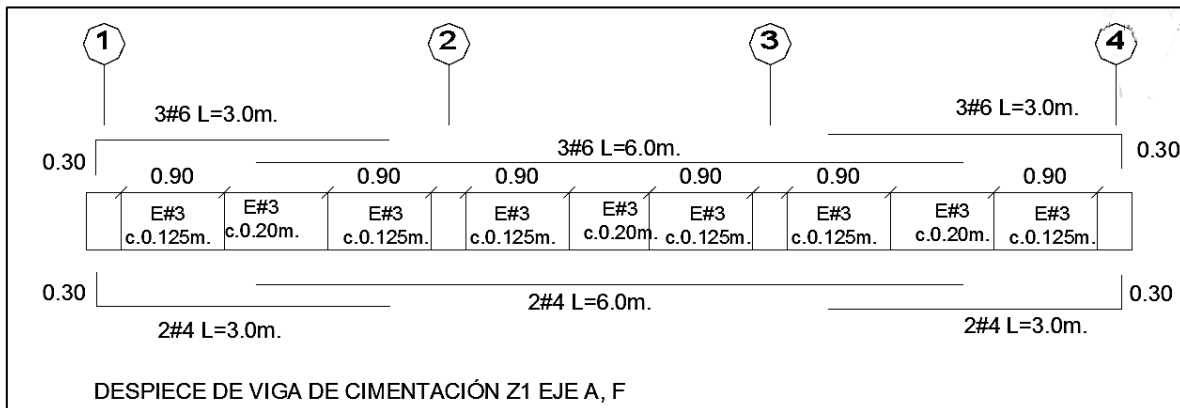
Figura XII Despiece de viga de cimentación de zapata Z1 eje A y F.
